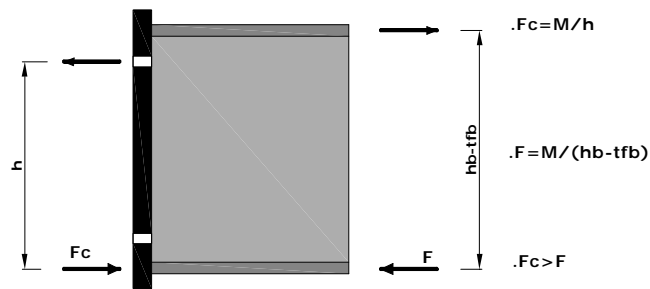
effort de compression localisé dans la semelle de la poutre [10].
